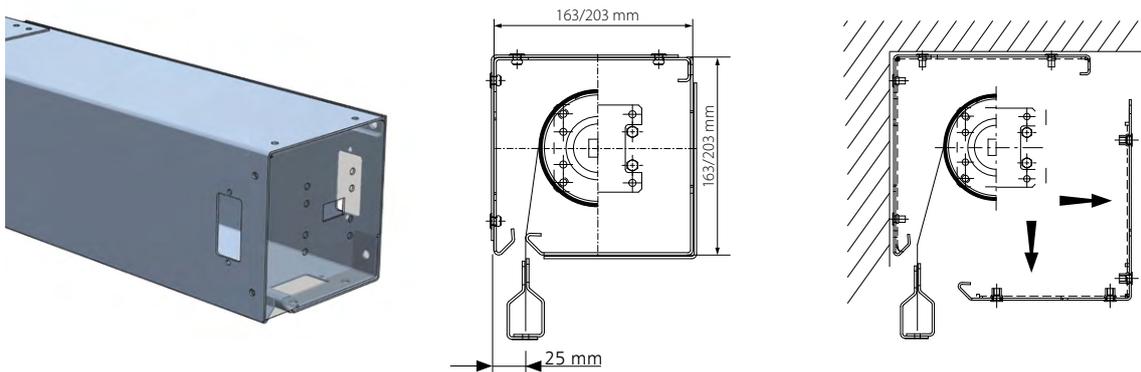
Gehäusetyp L – das Gewebe wird 25 mm von der Gehäusekante abgerollt, Wand- und Deckenmontage möglich, das Gewebe rollt dicht an der Wand ab
